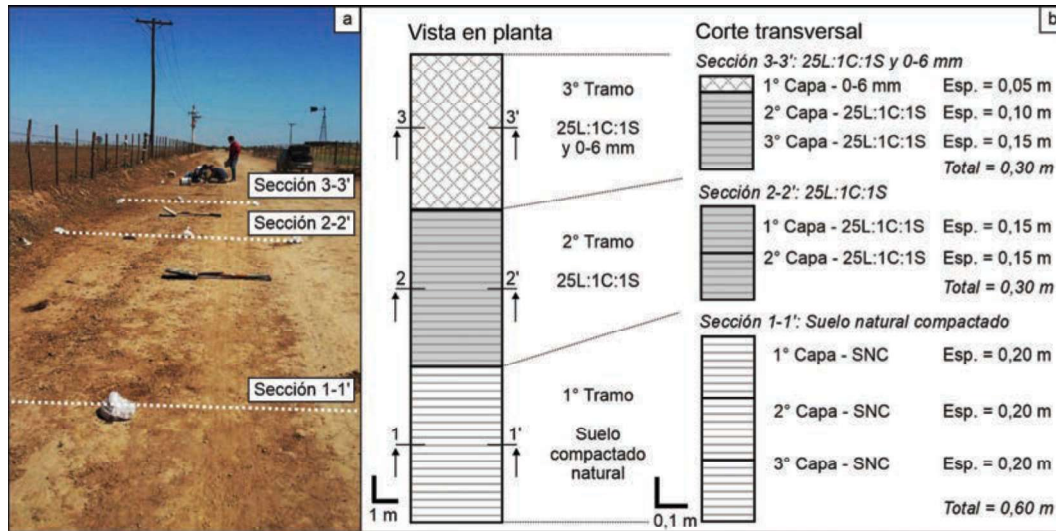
a) Vista de los tres tramos de subrasante materializados in situ; b) Detalle en planta y corte de los paquetes estructurales viales materializados in situ.
